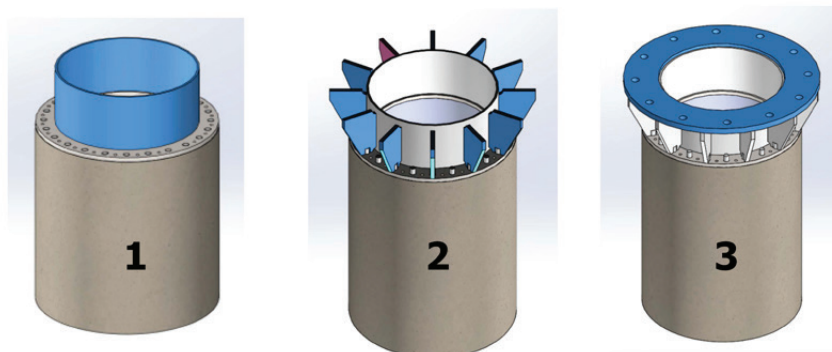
1) Установка трубчатой детали оголовка фундамента
